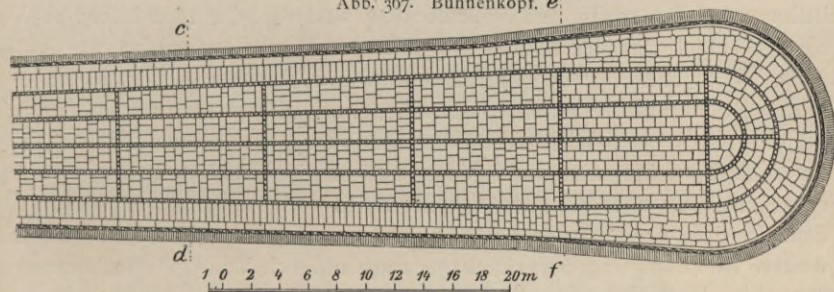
und 367. Grundriss der Steinbuhnen auf Norderney.
